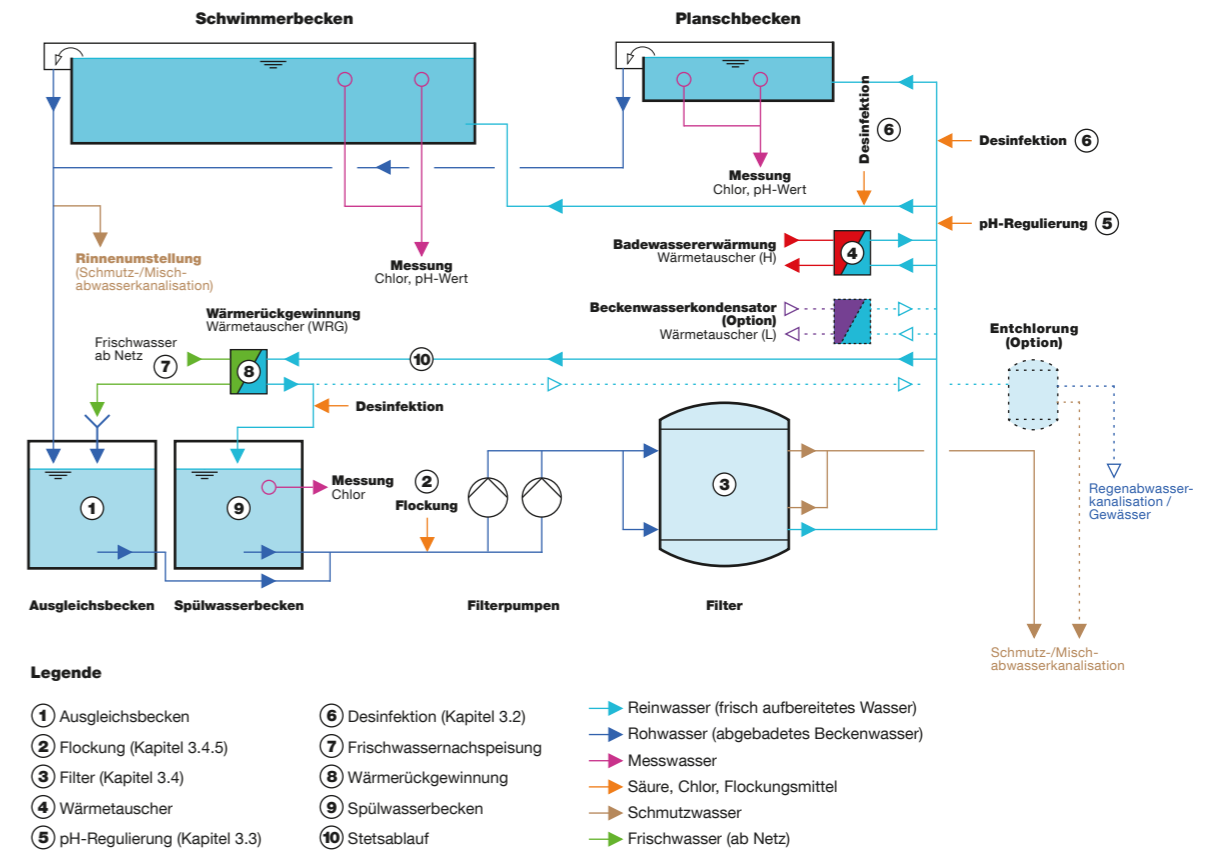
Prinzipschema einer Badewasseraufbereitungsanlage
